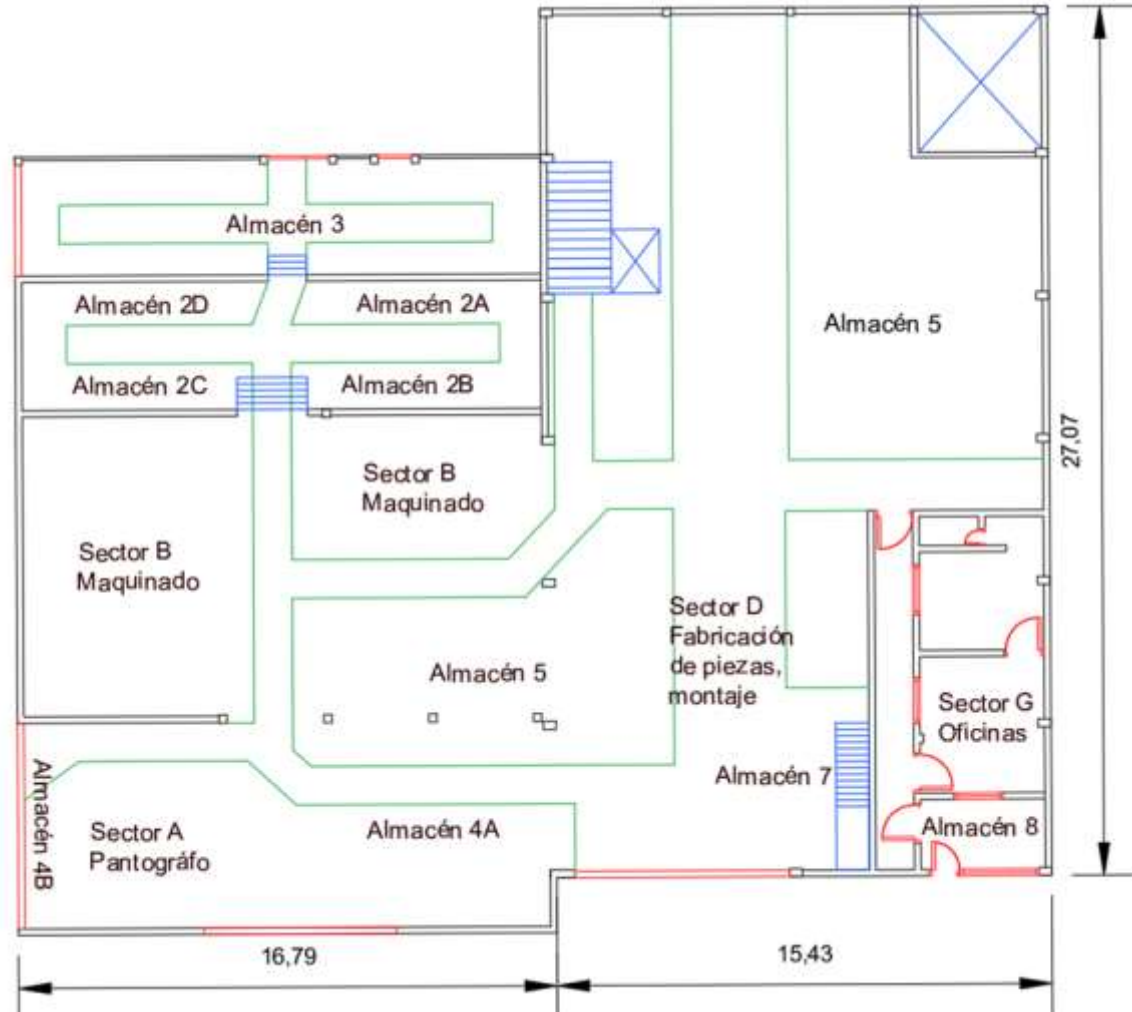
Lay-out planta superior. Fuente: Elaboración propia
